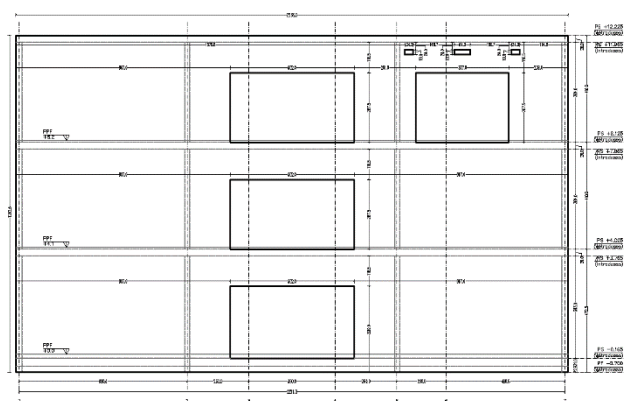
Prospetto sud-est setti scuola: strutture in progetto
